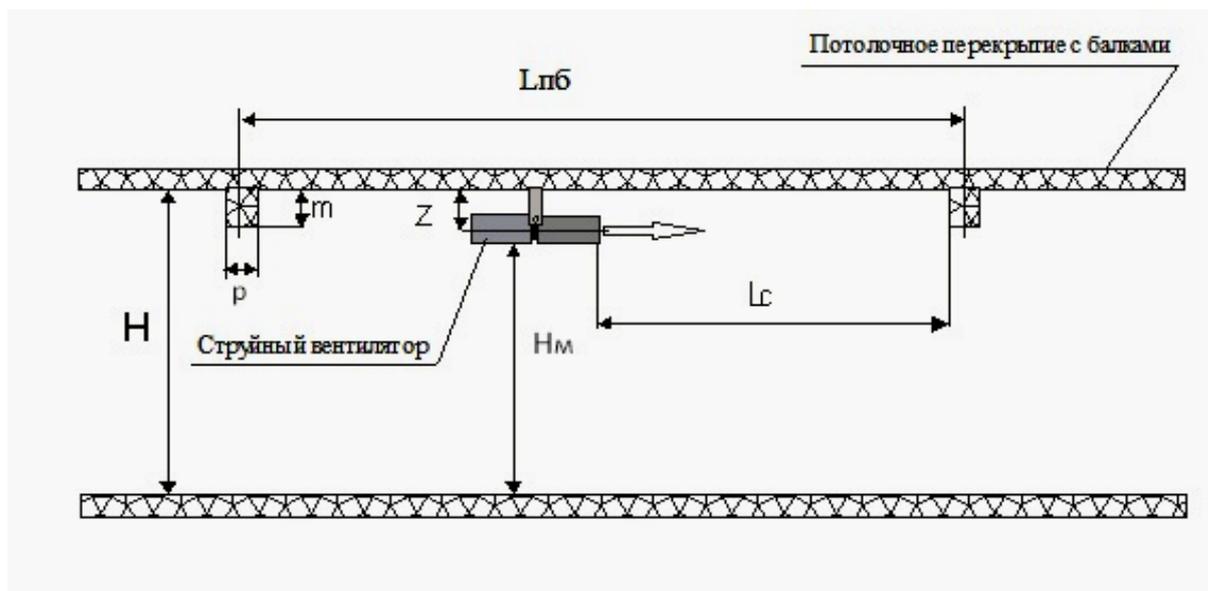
Схема расположения струйного вентилятора на потолочном перекрытии.
